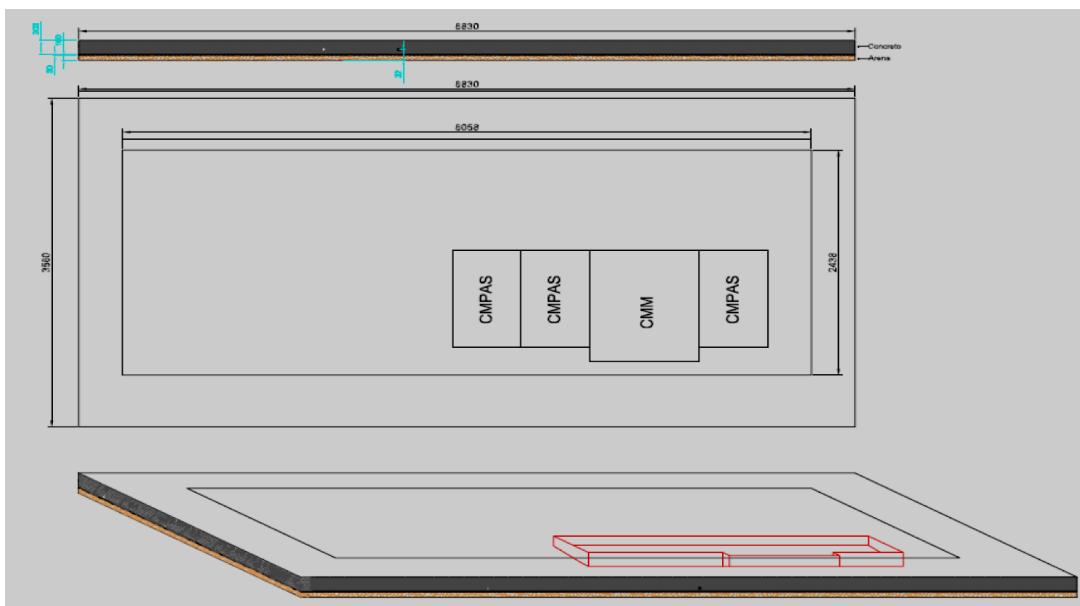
Detalle de las estructuras que soportarán los paneles
